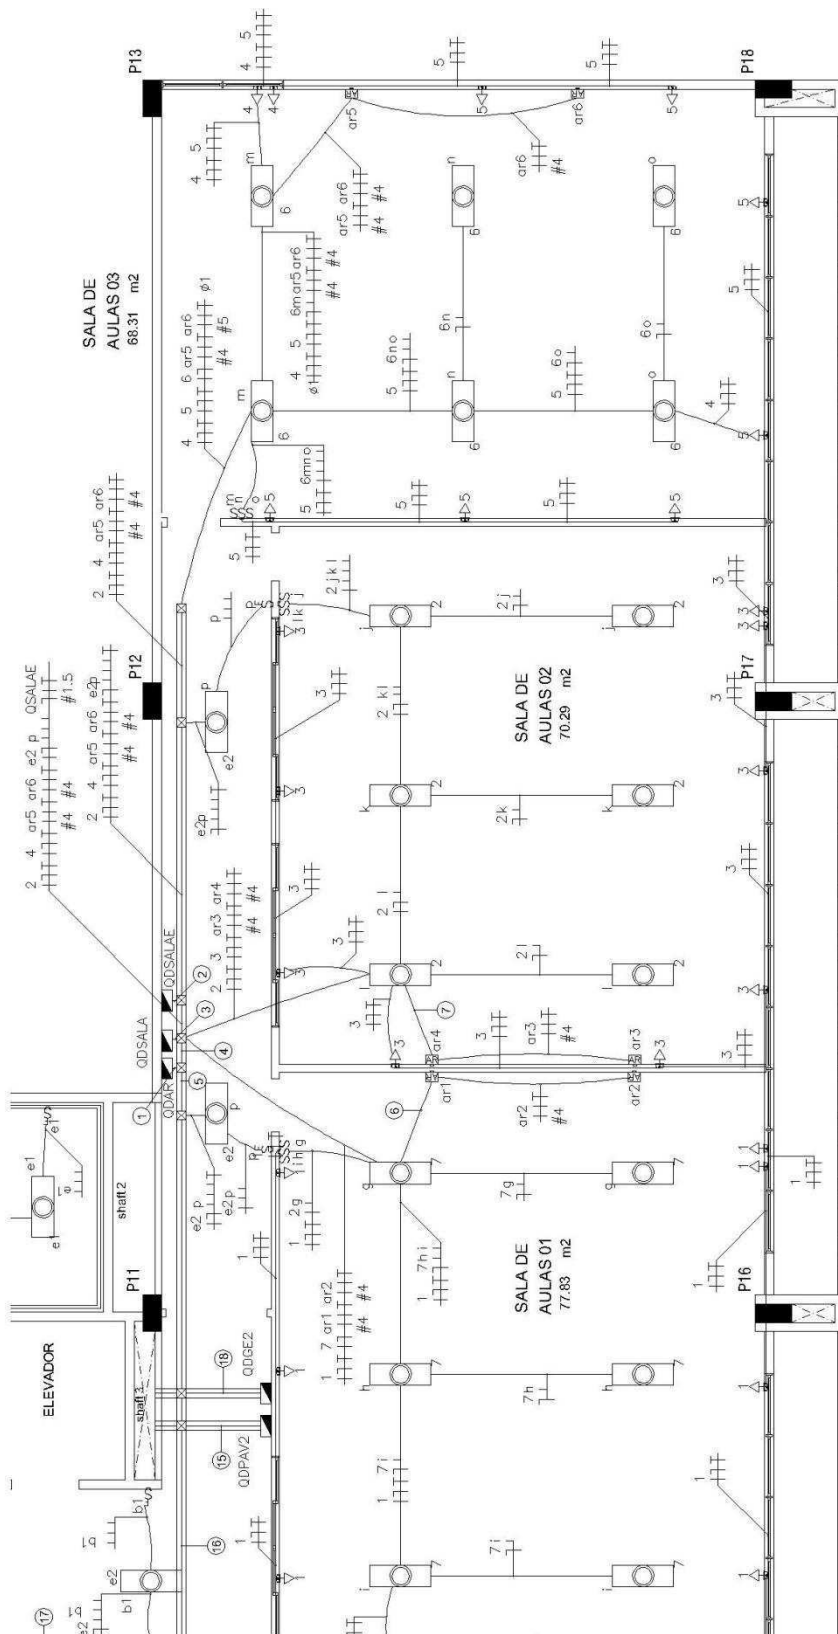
Planta baixa projeto elétrico do 2º pavimento do ICS
